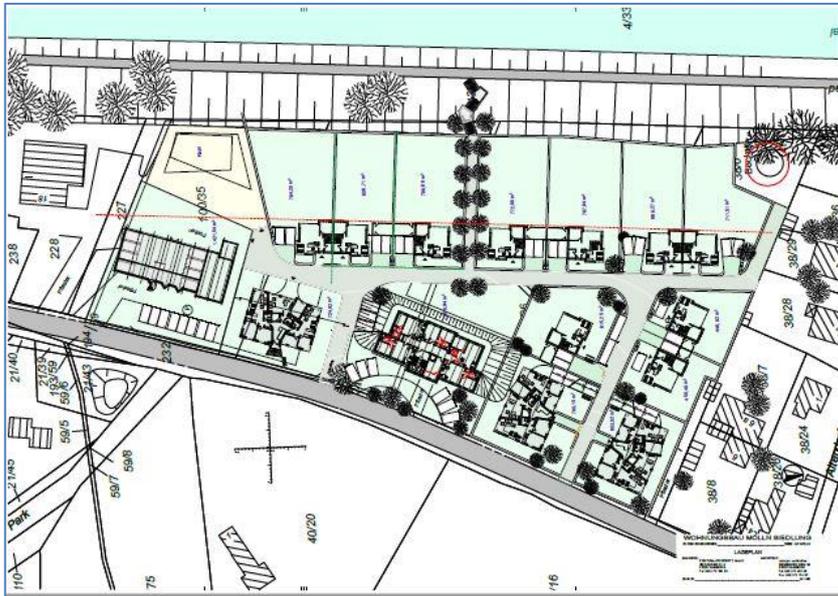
Lageplan-Entwurf (Roderjan Architekten, Stand: April 2020), B-Plan Entwurf BSK Mai 2021
